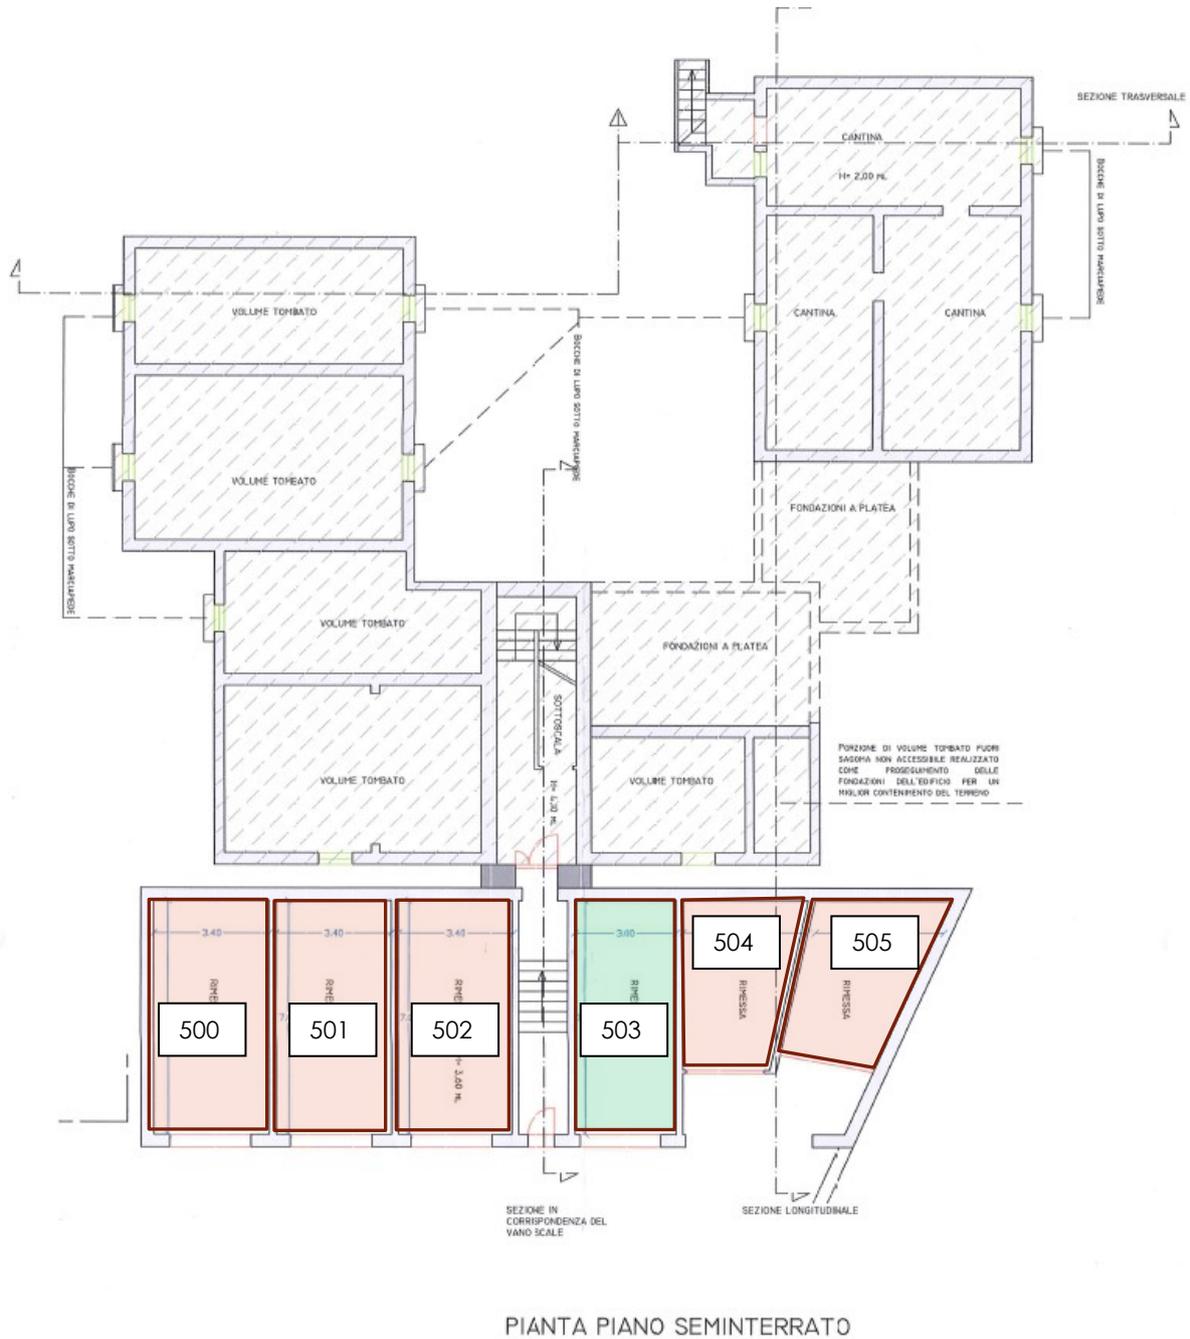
ESTRATTO PLANIMETRICO DA PE 136/19 CON INDICAZIONE DEI SUB E DEI CORRISPETTIVI INTERNI
